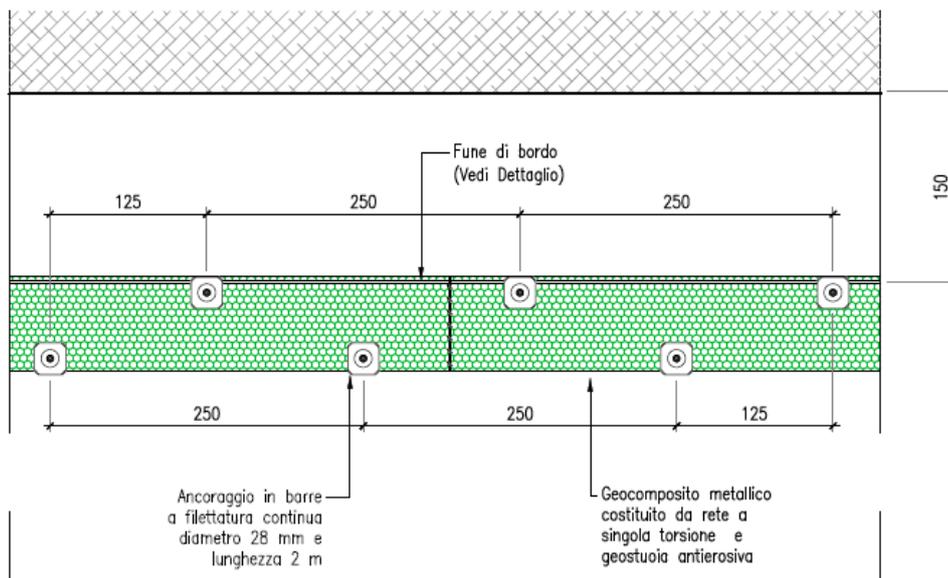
Sezione trasversale tipologica d'intervento tipo A
